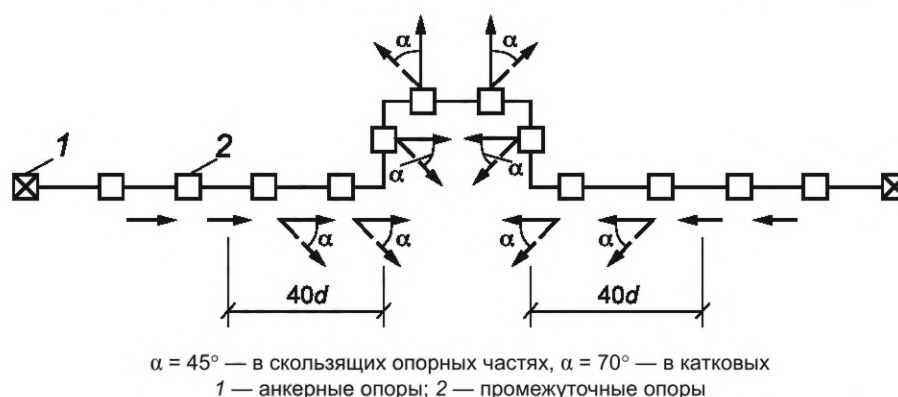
Направления горизонтальной нагрузки в местах подвижного опирания трубопроводов от отдельно стоящие опоры при нагревании трубопроводов
